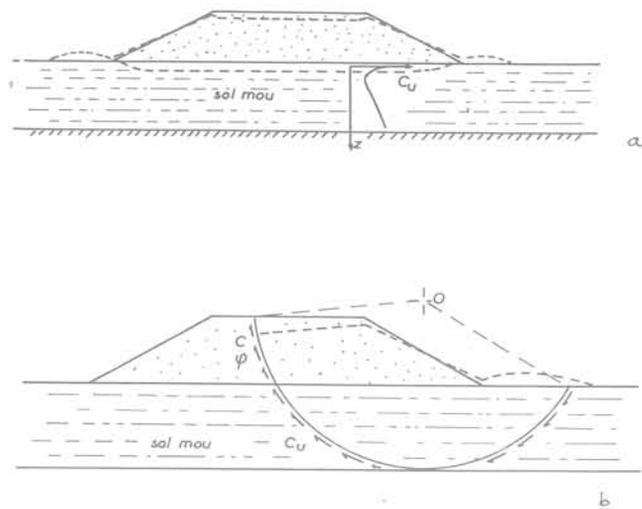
Modes de rupture d'un remblai construit sur argile molle
